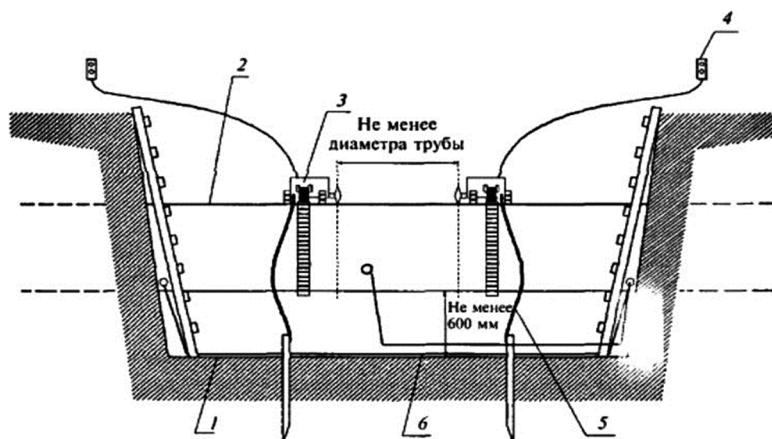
Схема безогневой вырезки участка нефтепровода труборезами: 1 – рабочий котлован; 2 – трубопровод; 3 – труборезы; 4 – пульт управления труборезом; 5 – провода заземления машинок труборезов со штырями; 6 – шунтирующая перемычка
